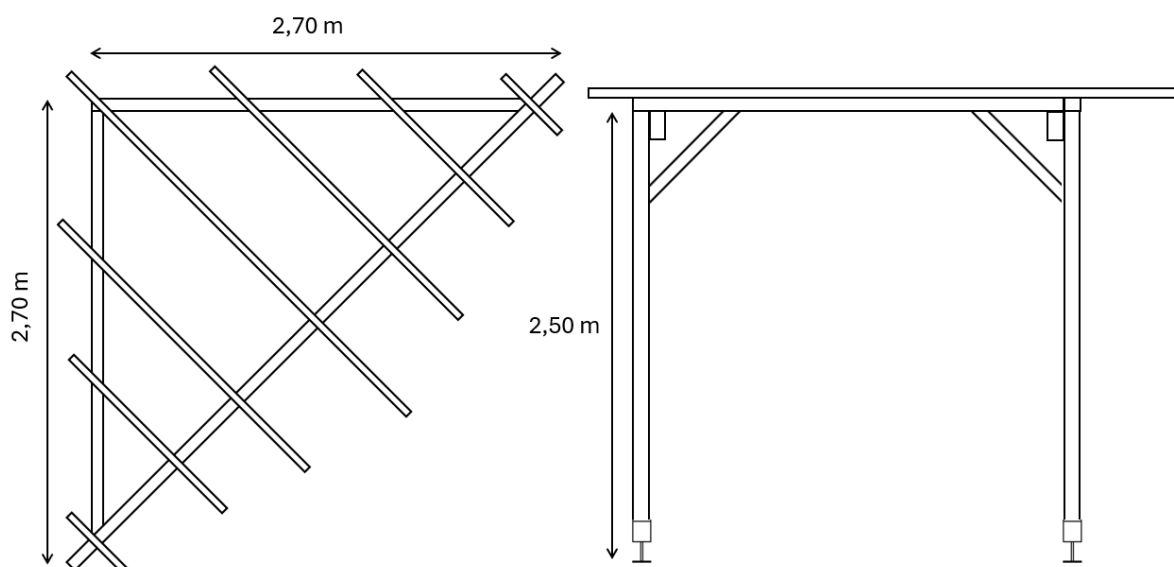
Dreieck-Pergola (2,7x2,7 m) Draufsicht (links) und Seitenansicht (rechts)
